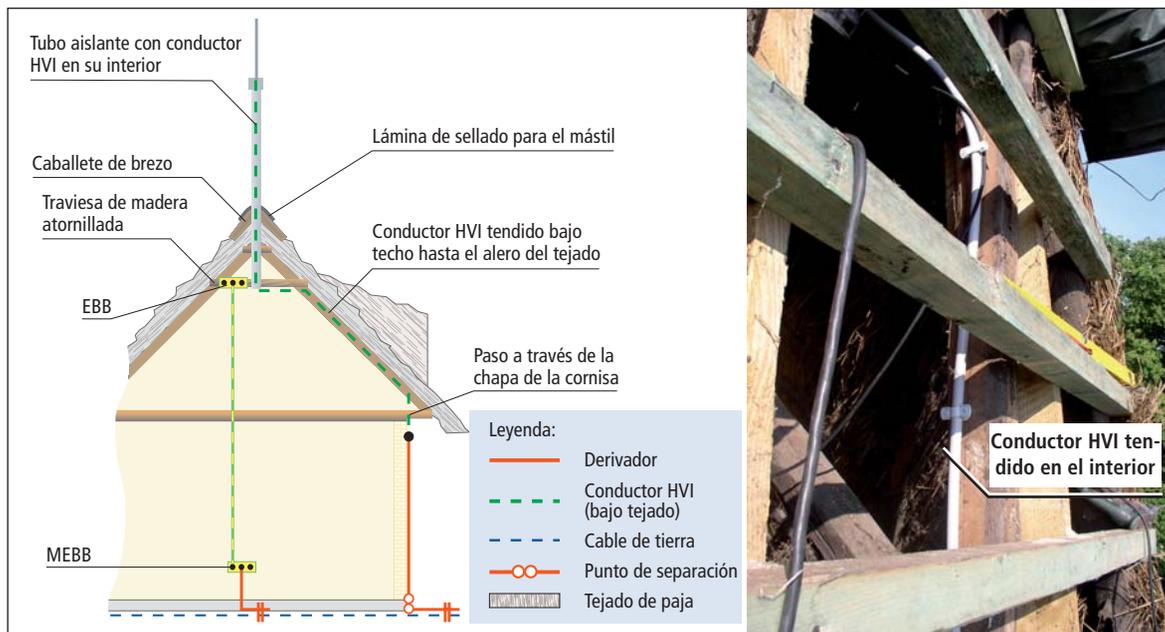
Representación esquemática del tendido de los derivadores en las vigas del tejado.
